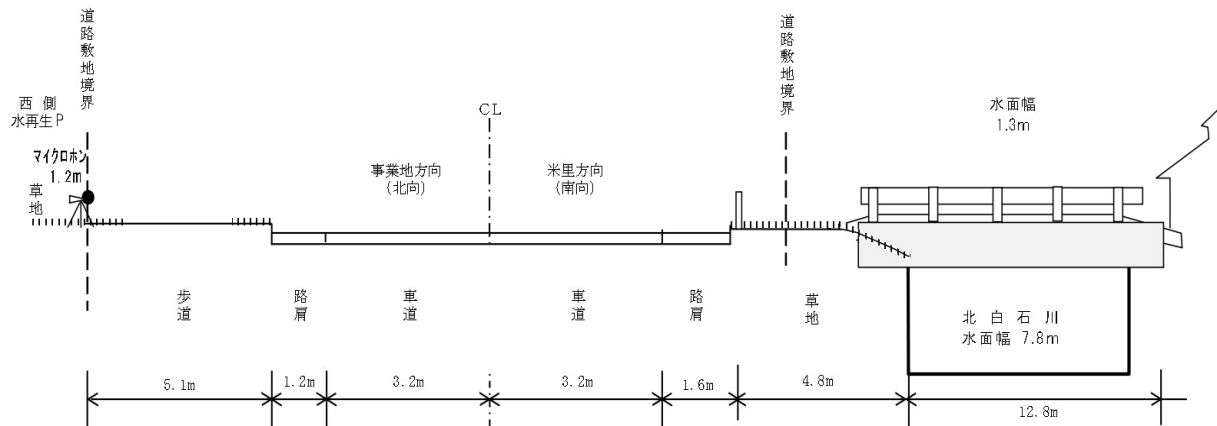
(4) 道路断面図 (K-4 地点 道道 626 号東雁来江別線)
